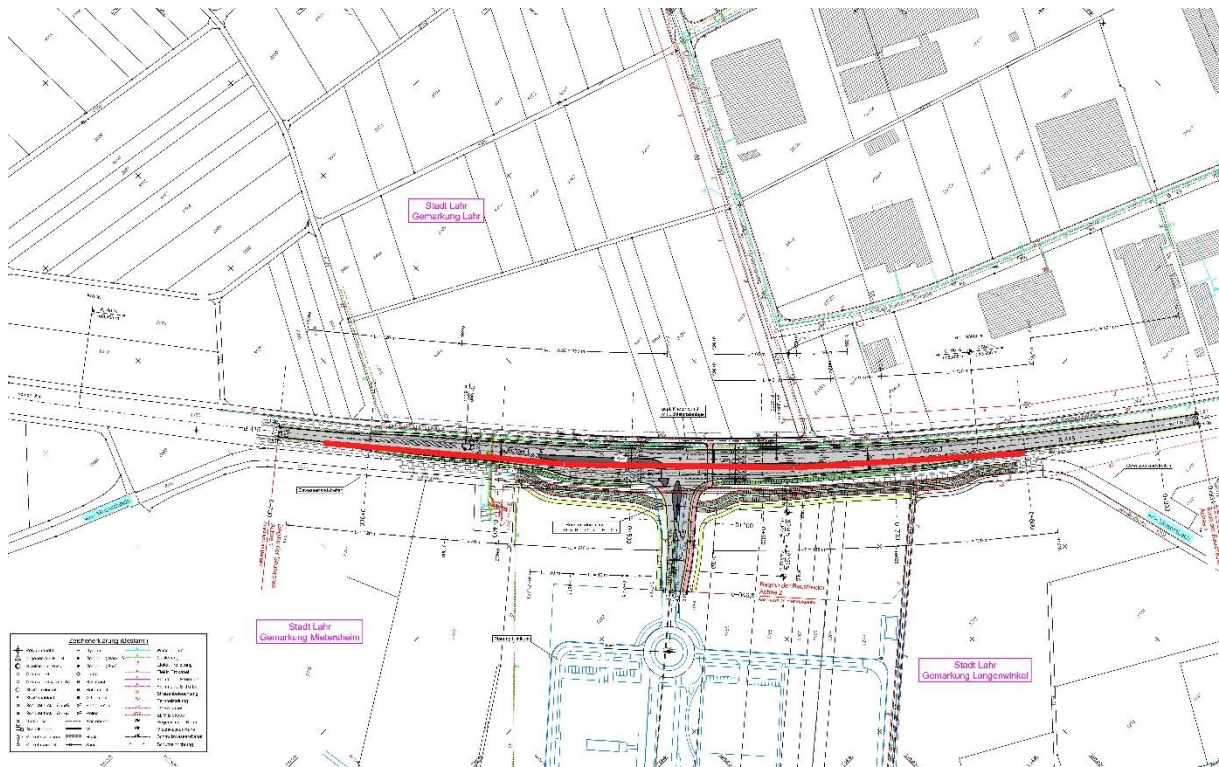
Plangleiche Lichtsignalanlage (3-armig)
